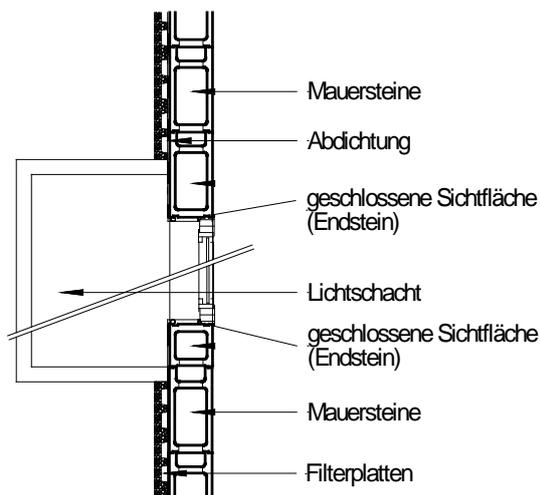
Grundriss: Kellerwand mit Fenster
